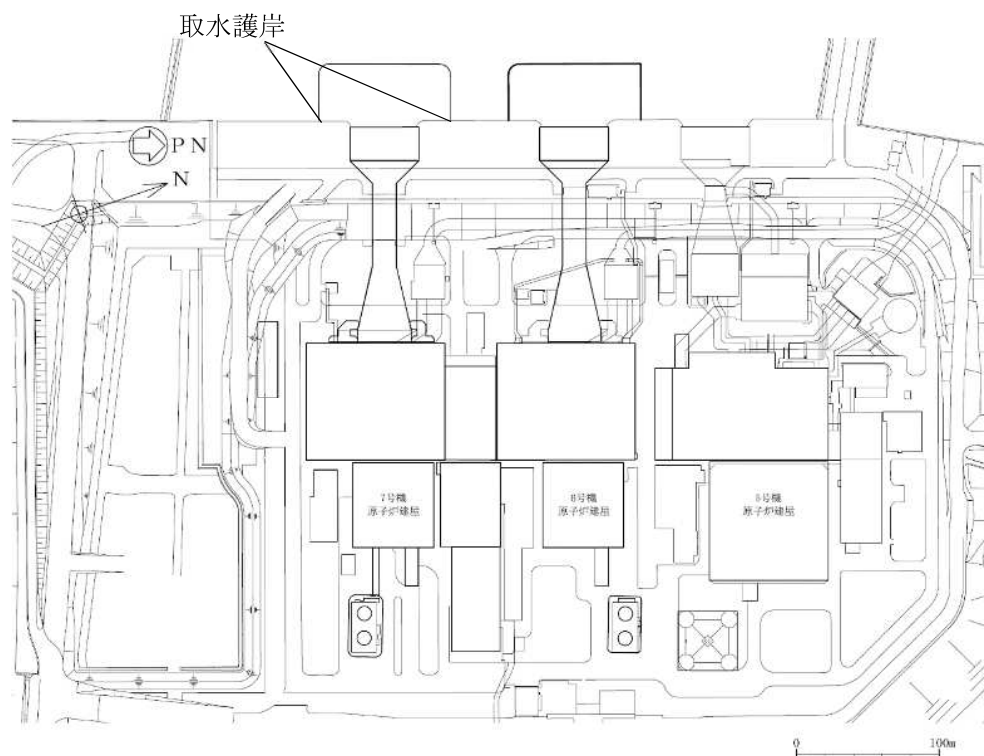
(1) 取水護岸の位置図 (全体平面図)
